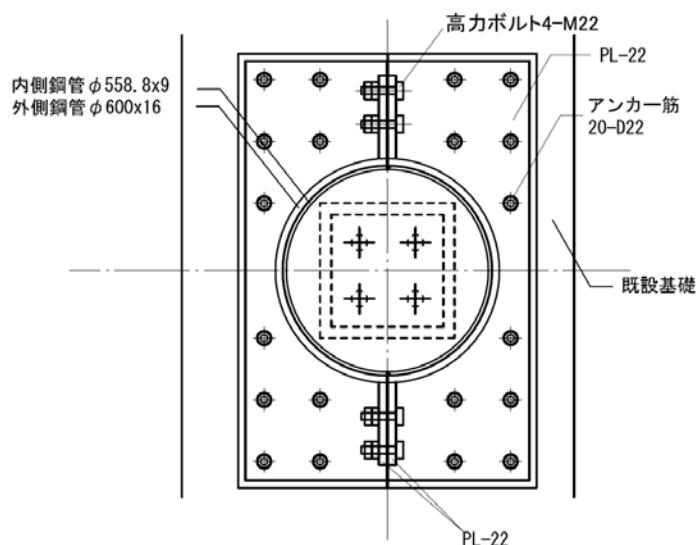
補強鋼管とあと施工アンカ一詳細 (伏図)
